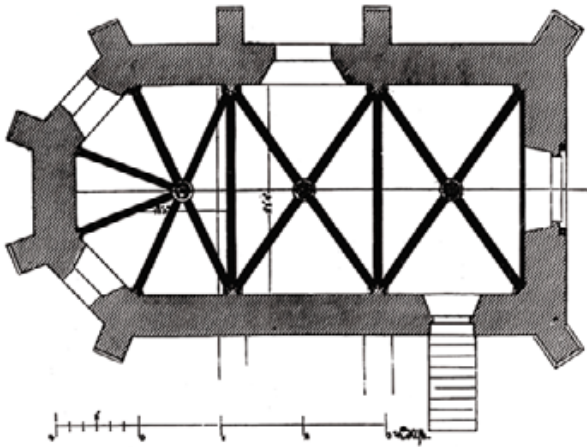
Stein, Förthofkapelle. Grundriss (Aufnahme 1877).
